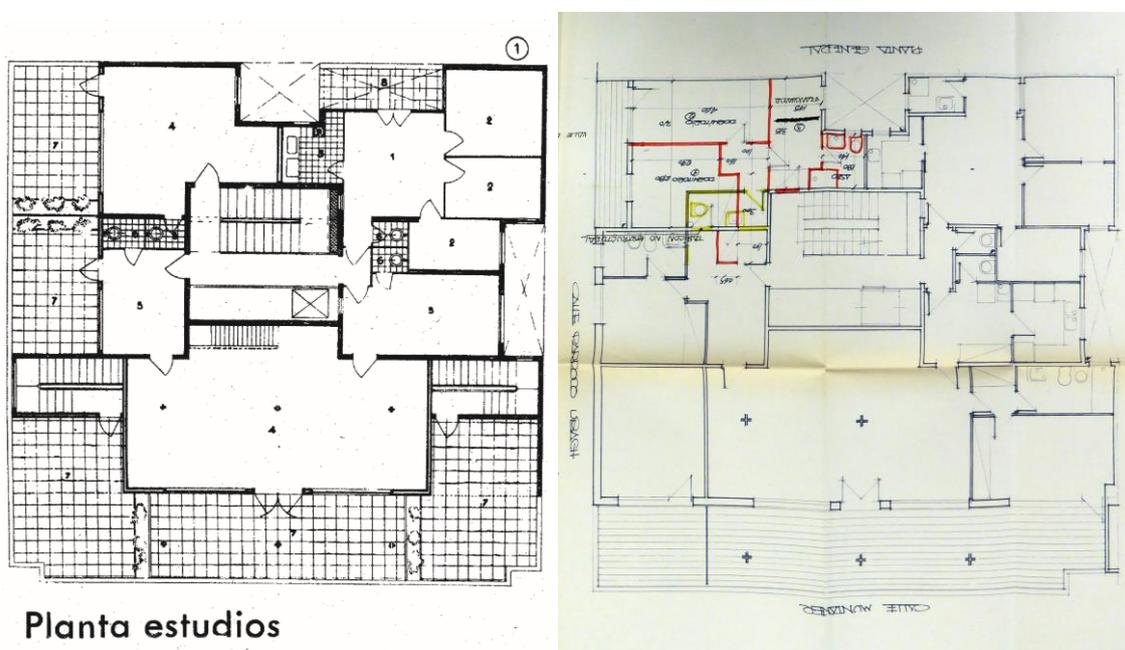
Izquierda, planta ático según proyecto original de Sert. (Revista AC. 1931. Pp. 19) Derecha, "Proyecto de reforma de vivienda sita en C/Muntaner 348" del arquitecto Santiago Roquetas Macías. Se representa en amarillo los tabiques a demoler y en rojo los de nueva ejecución. Nótese el aumento de superficie de la planta séptima dibujada en 1972 respecto al proyecto original. Carpeta 86961. 1972. Papel. Arxiu Contemporani de Barcelona. Plano sin numerar.
